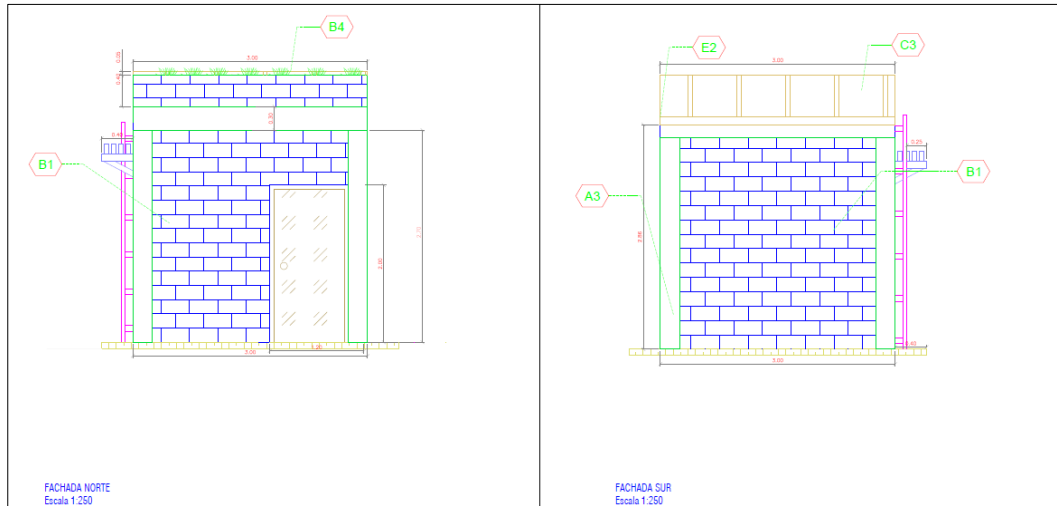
Planos arquitectónicos de las unidades. Fachada NORTE y SUR
